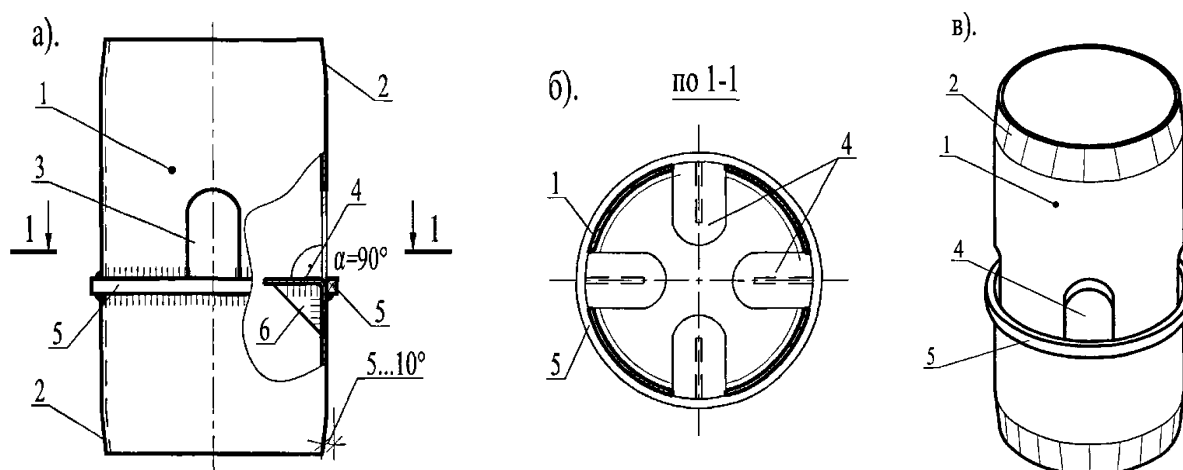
Конструкція з'єднувальної гільзи для балкового перекриття
